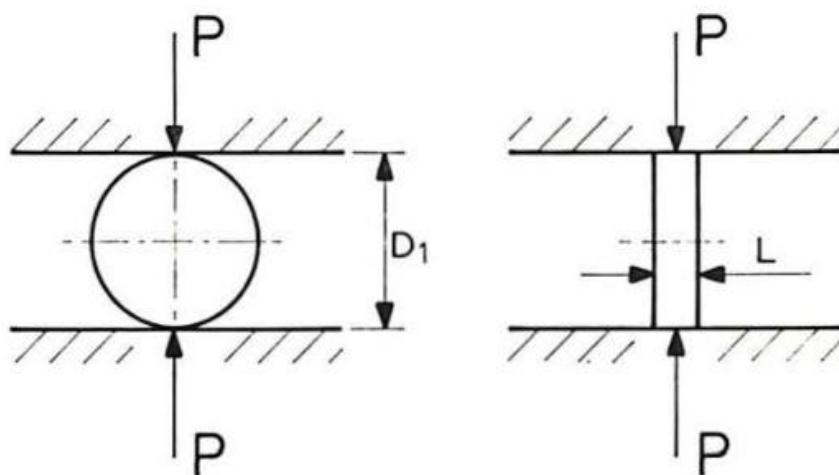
Dimensões D e L (até 50 mm) de um corpo de prova cilíndrico montado para o ensaio de compressão diametral através da aplicação de uma carga P (adaptado [49]).
